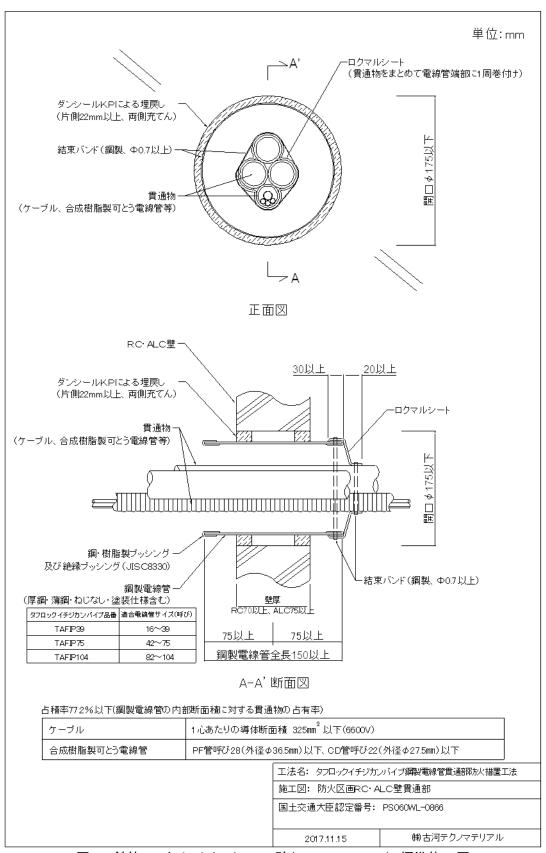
鉄筋コンクリート(RC)・ALC 壁(PS060WL-0866) 標準施工図
